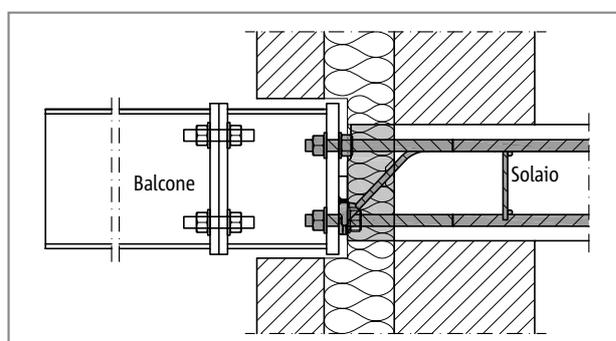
Schöck Isokorb® T tipo SKP: materiale isolante nell'interposto isolamento; con l'elemento di collegamento in opera tra Isokorb® e balcone si garantisce alla costruzione maggiore flessibilità
